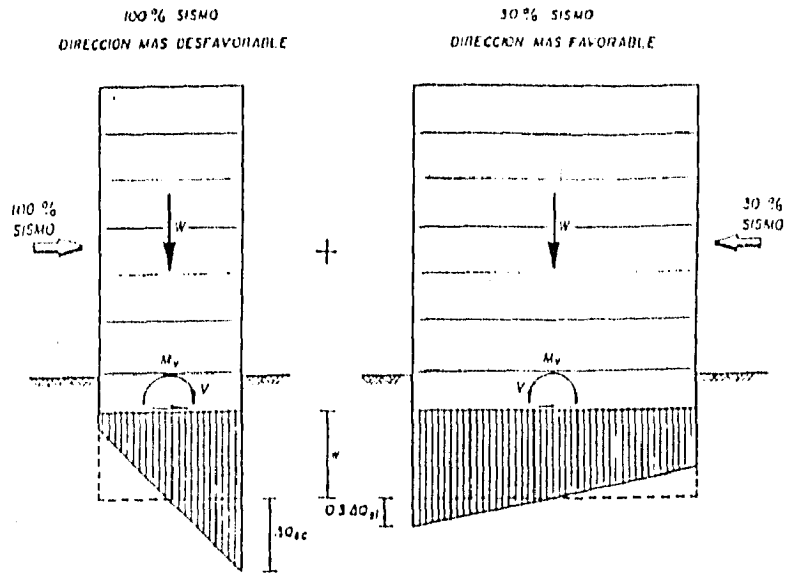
FUERZAS ACTUANTES EN PILAS PROFUNDAS COLADAS EN SITIO (REF.7).
